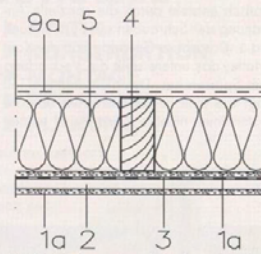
Decke unter nicht ausgebautem Dachgeschoß, nicht belüftet, mit zusätzlicher Installationsebene an der Unterseite
